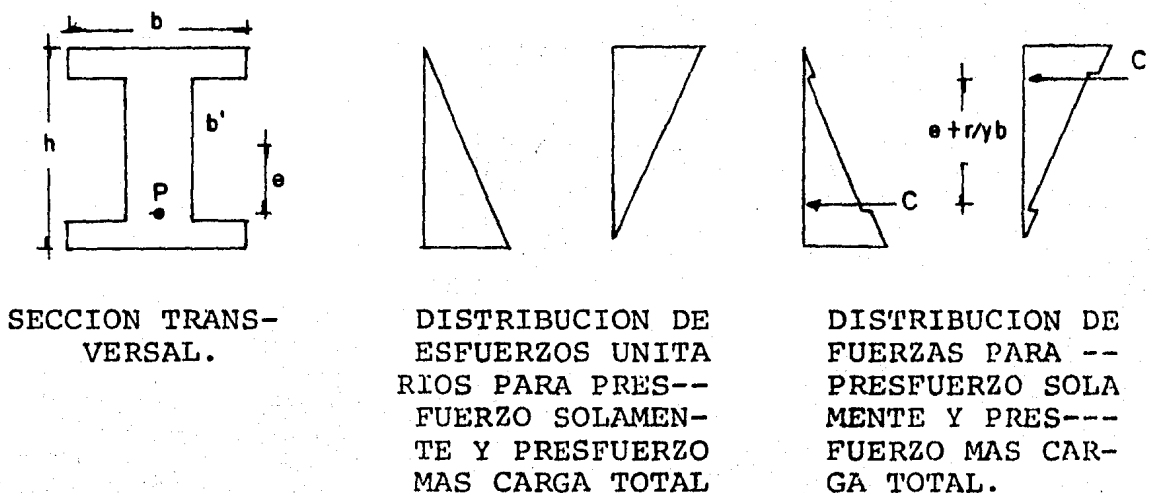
Distribución de esfuerzos unitarios y fuerzas en una viga de sección transversal I bajo presfuerzo solamente y presfuerzo más carga total.
